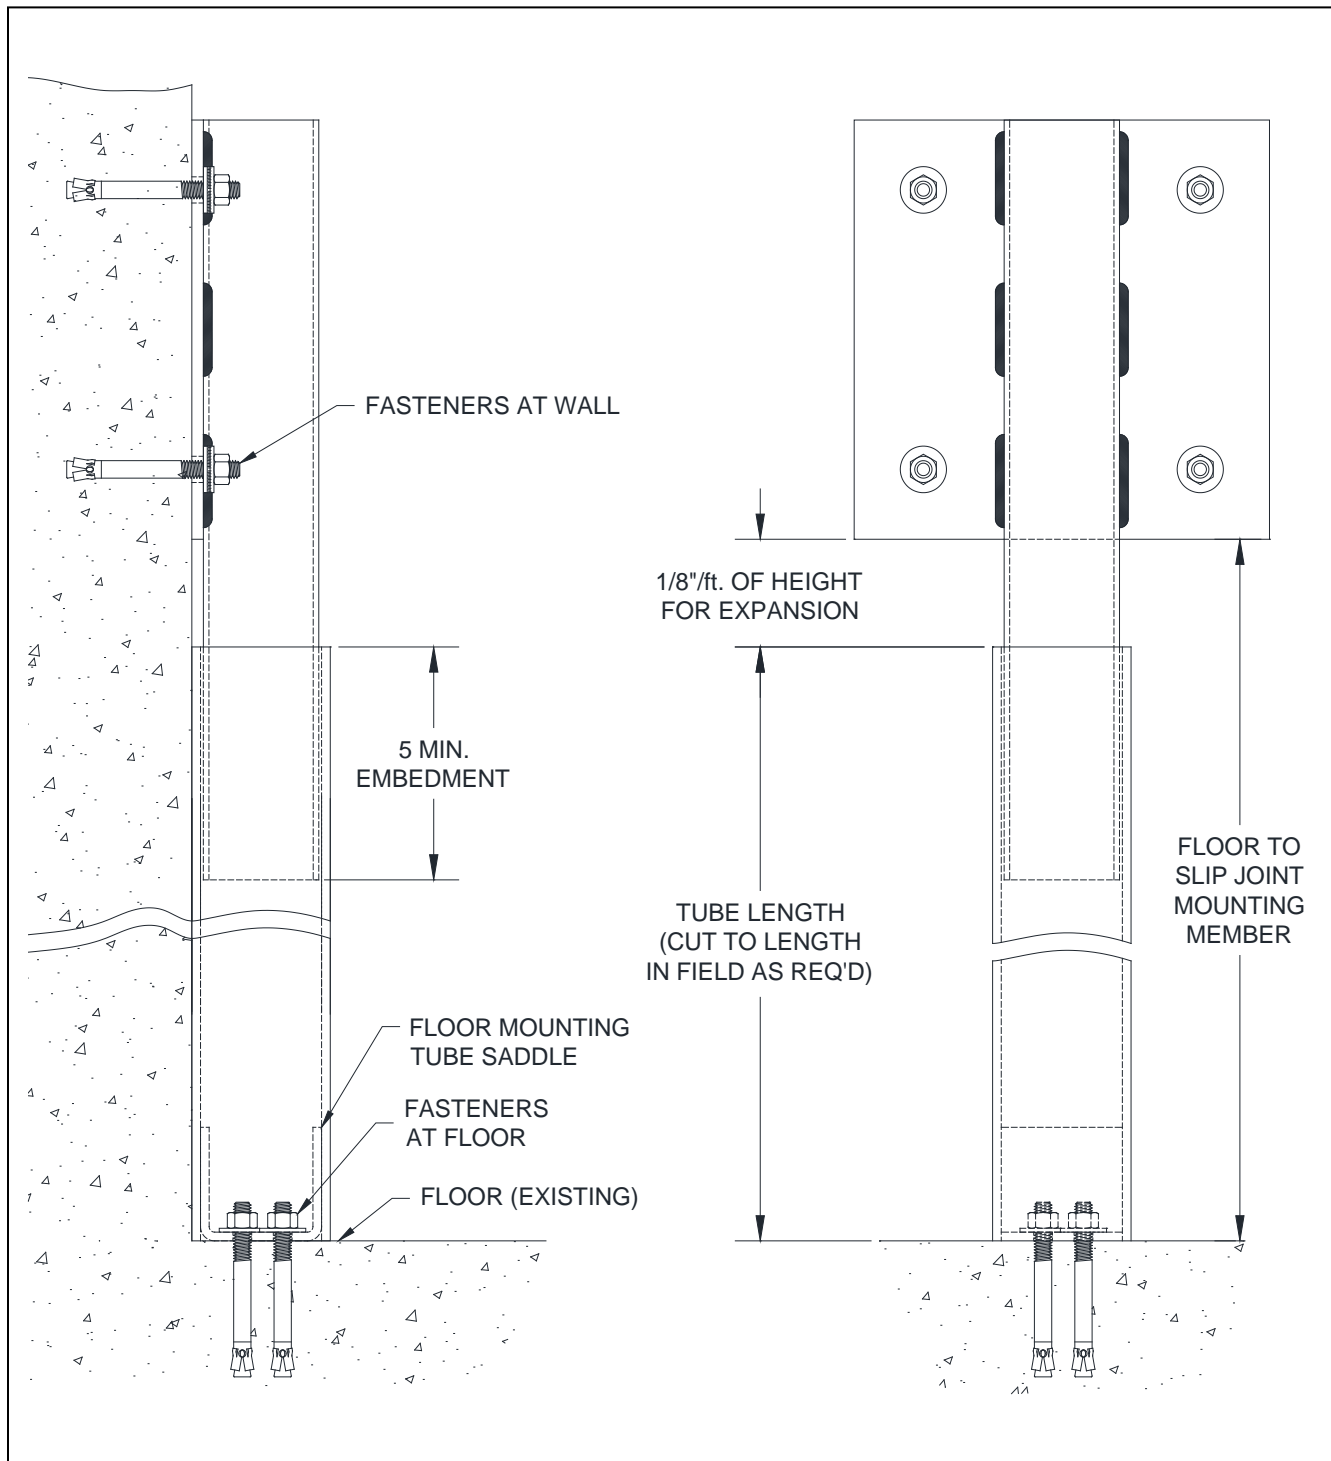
Junta deslizante – piso a pared con ensamble de montaje de placa
